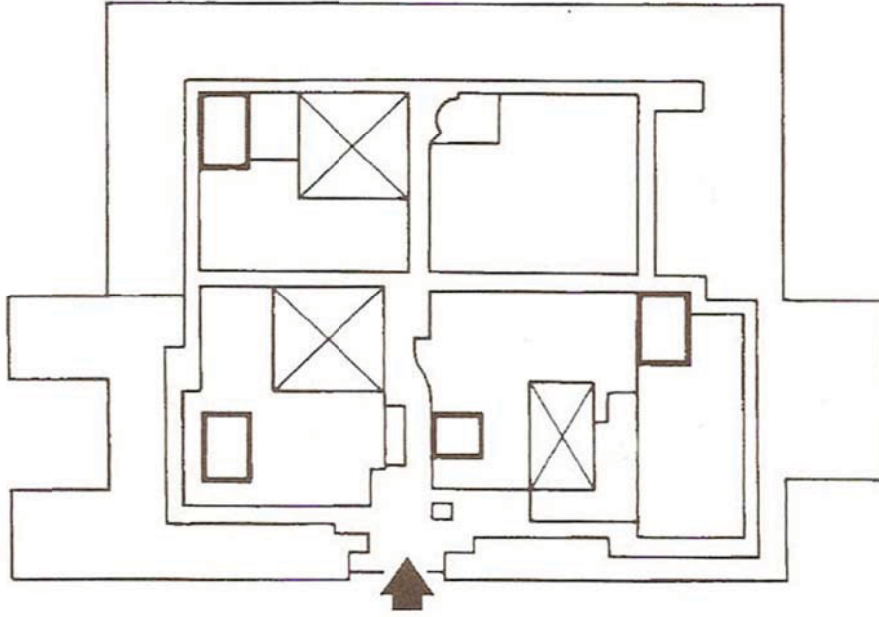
Pianta schematica del l'Hospital Design Unit a Greenwich.
